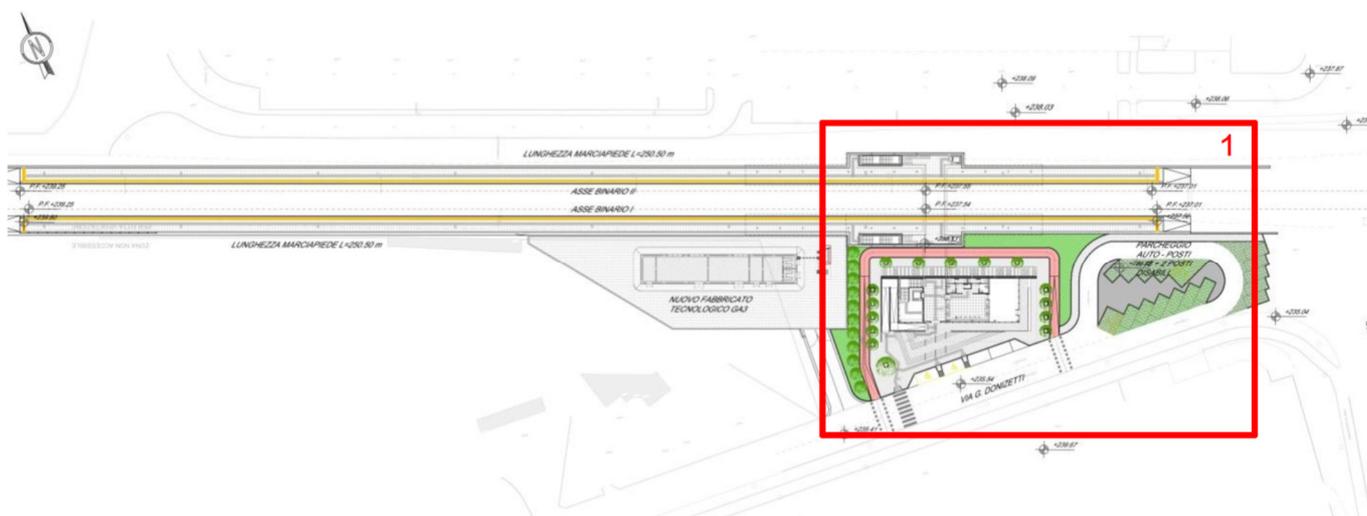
Inquadramento planimetrico della nuova stazione di Ponte San Pietro
